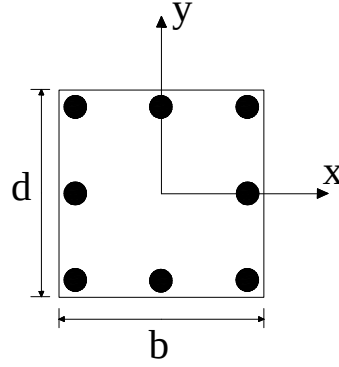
Dikdörtgen betonarme kesitlerde dört kenarda eşit donatı yerleşimi.
